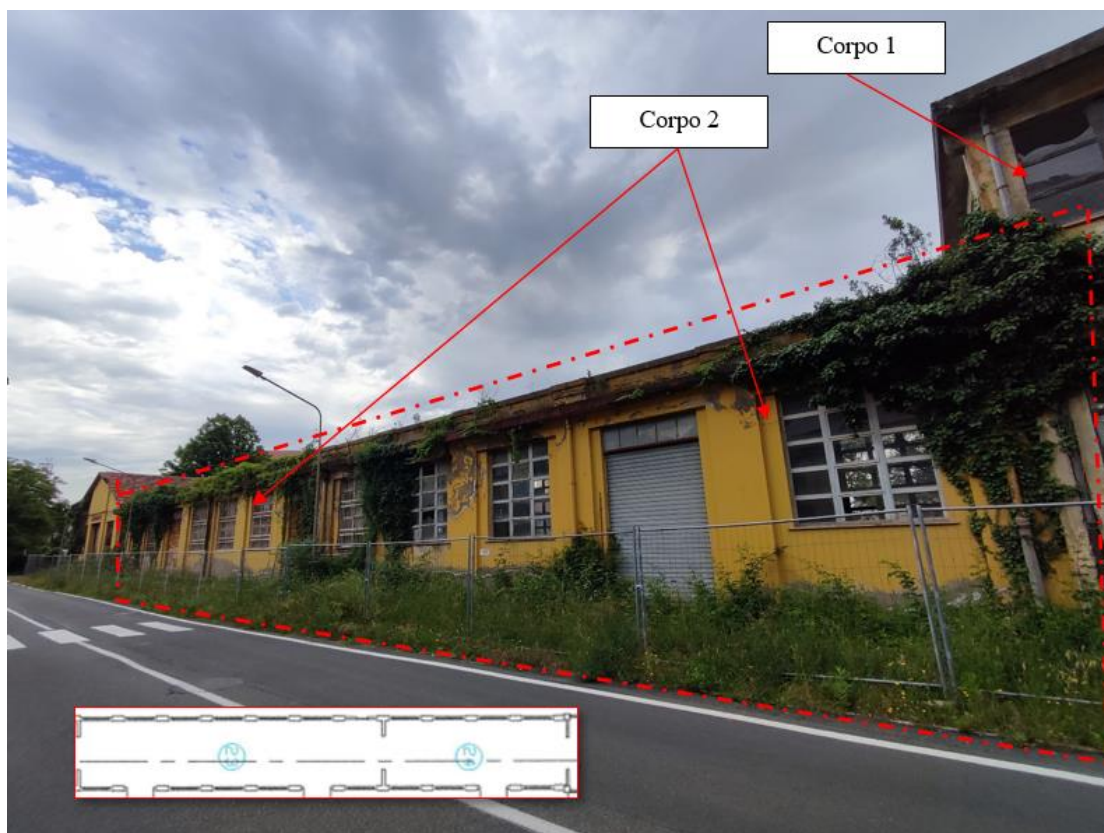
Fabbricato 152 (Corpo 2) - Vista esterna lato strada
